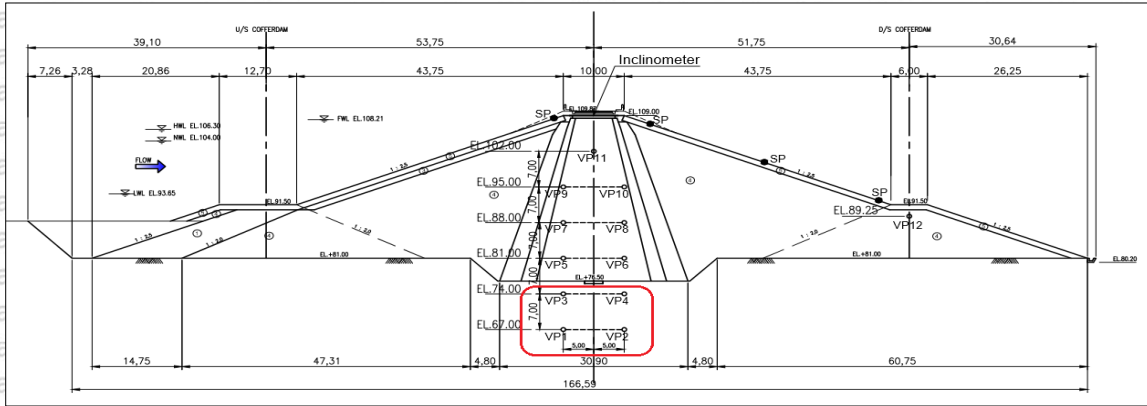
Denah Penempatan Instrumen Bendungan Raknamo
